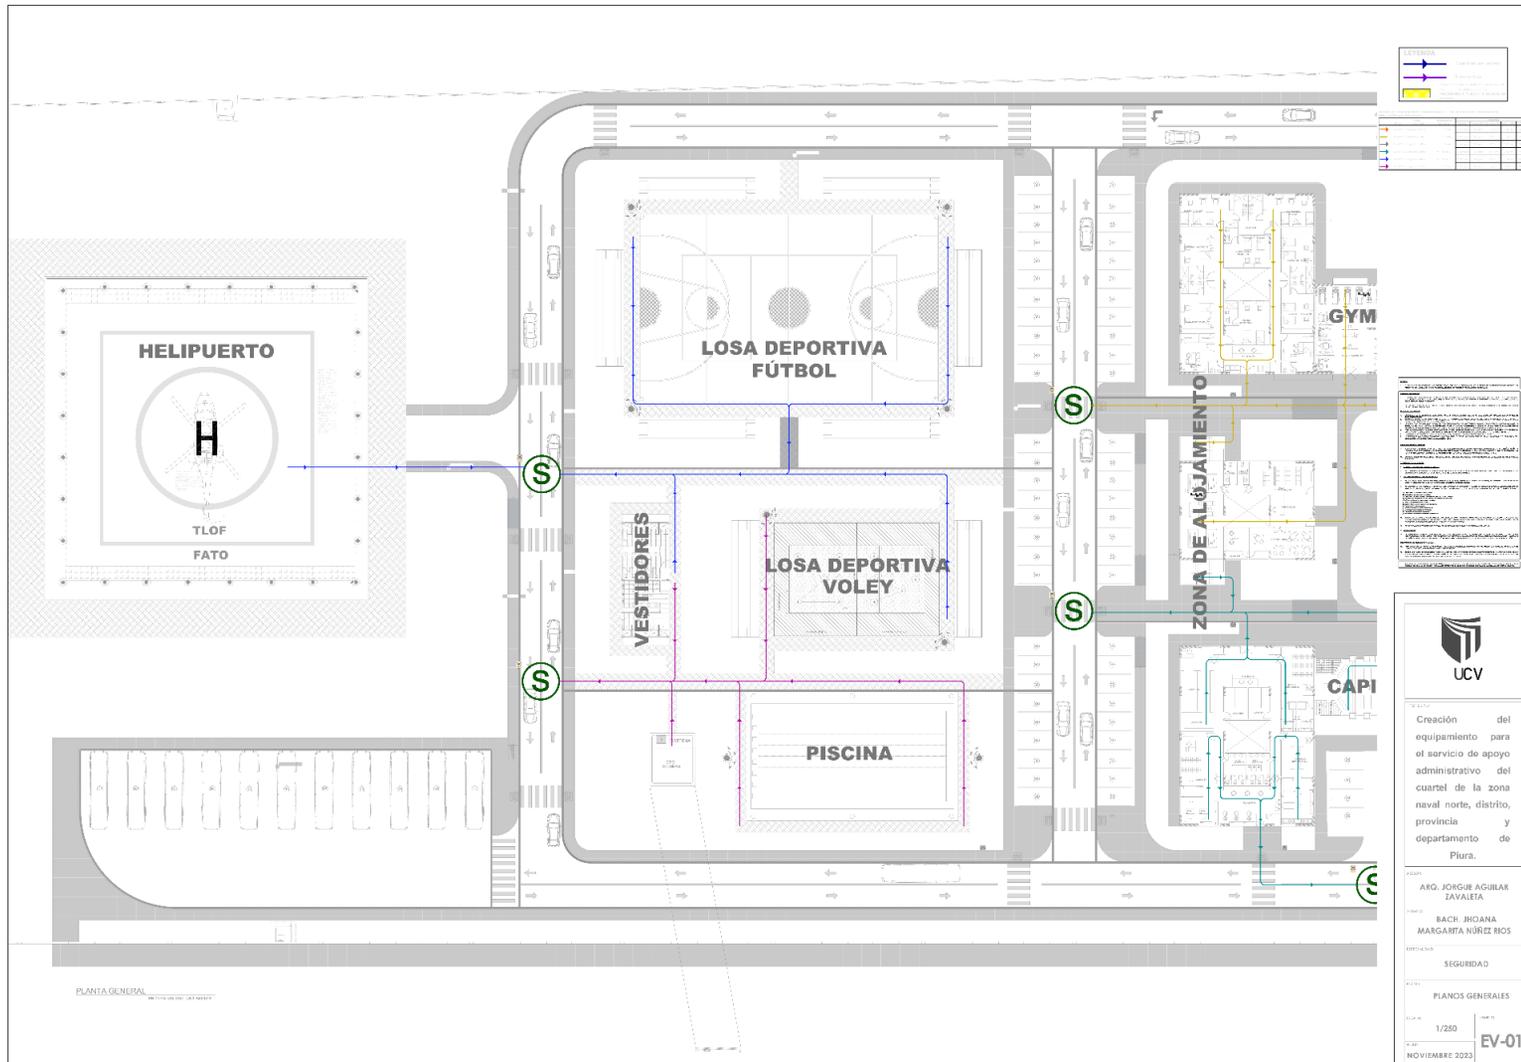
Planos Generales de Seguridad - Plano general – SECTOR 1
